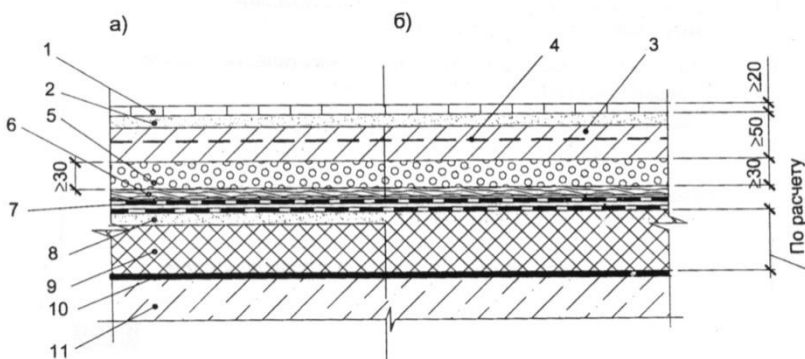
Эксплуатируемая под пешеходные нагрузки кровля с плиточным полом:
